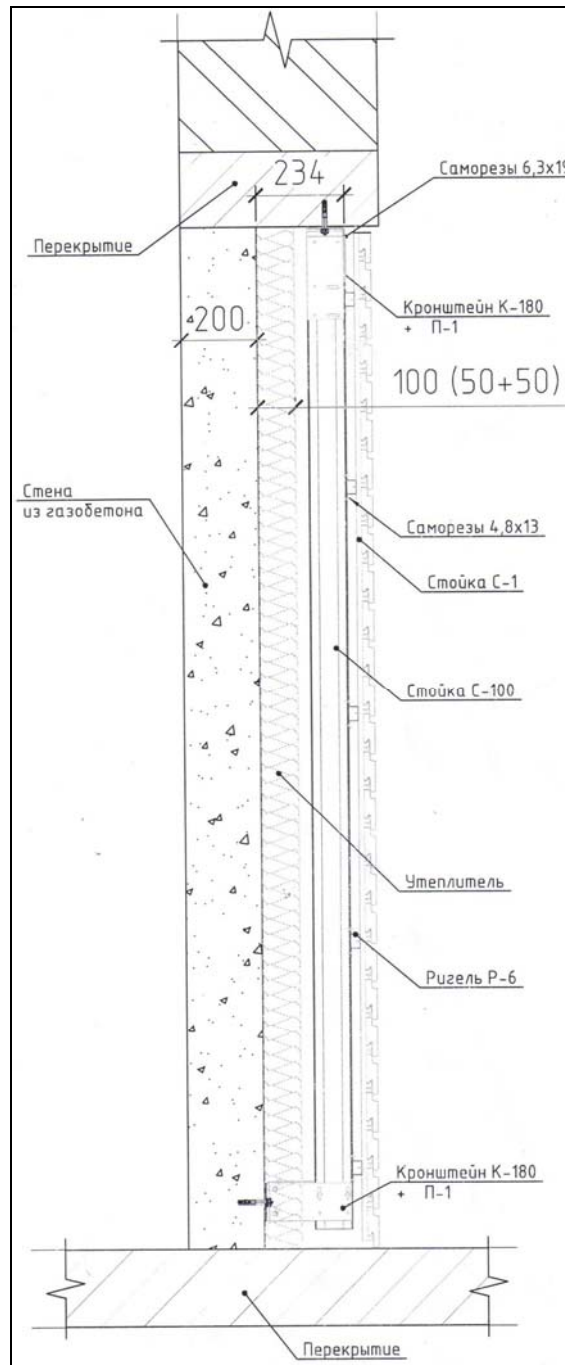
Конструктивна схема випробувального зразка зовнішньої стіни із газобетонних блоків густиною 400кг/м<sup>3</sup> з системою фасадного утеплення «СКАНПРОК»
